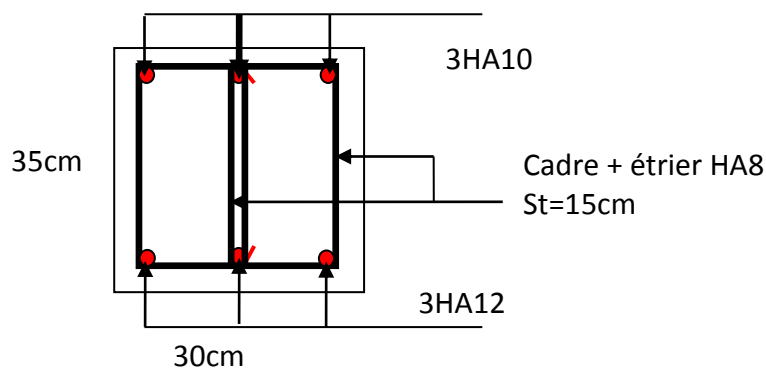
Schéma de ferrailage de la poutre de chaînage
